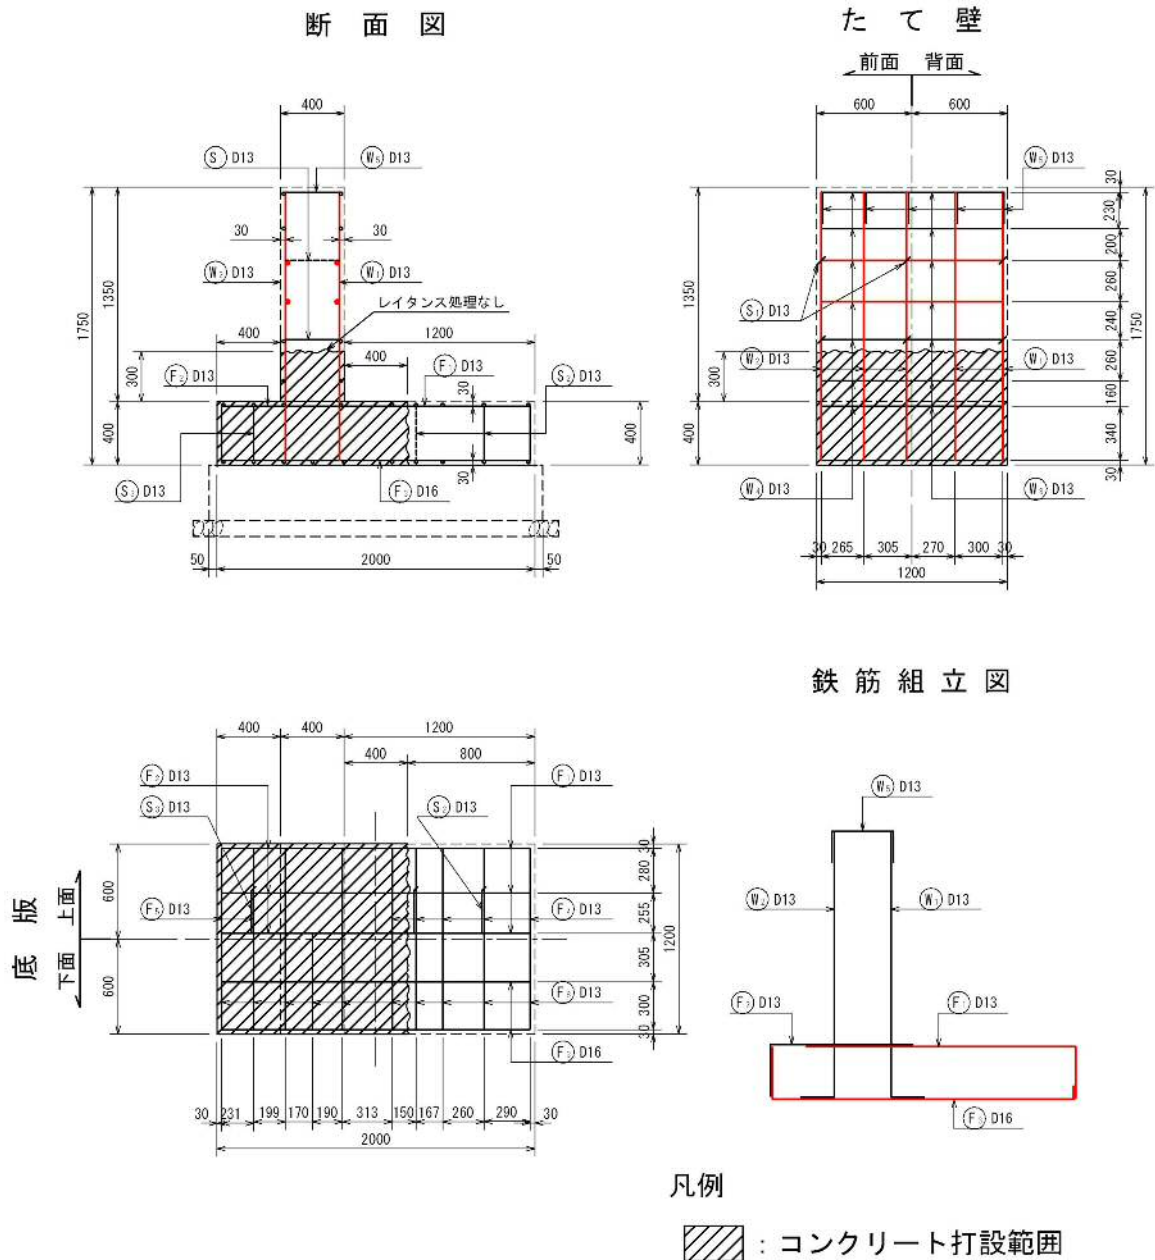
施工途中の鉄筋組モデル（かぶり不足・配筋ミス・打ち継ぎ面の処理）
